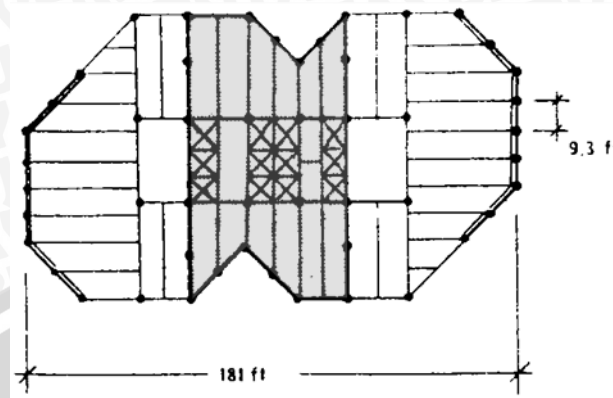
Denah Bangunan, Charlotte, North Carolina.
